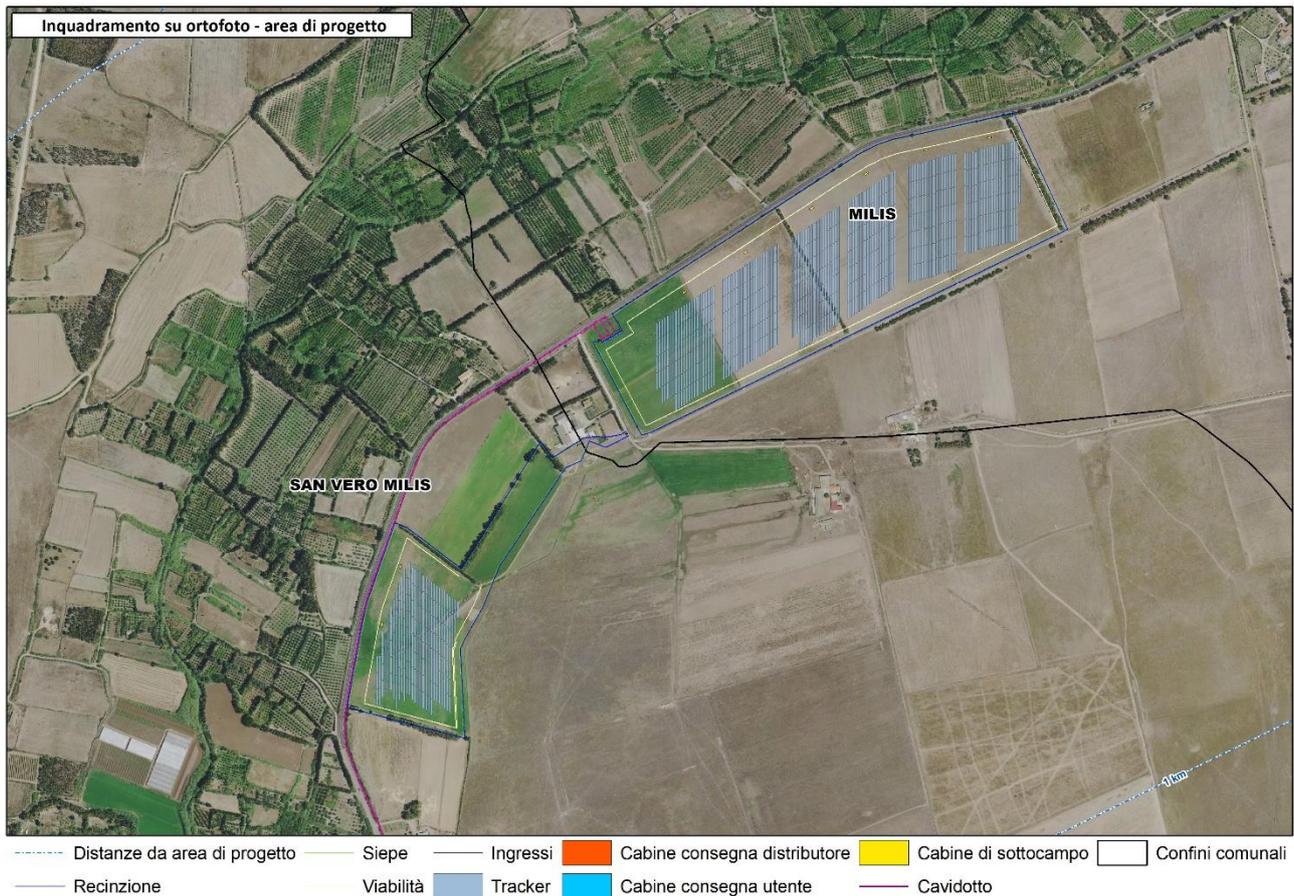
inquadramento su ortofoto - vista di dettaglio.
